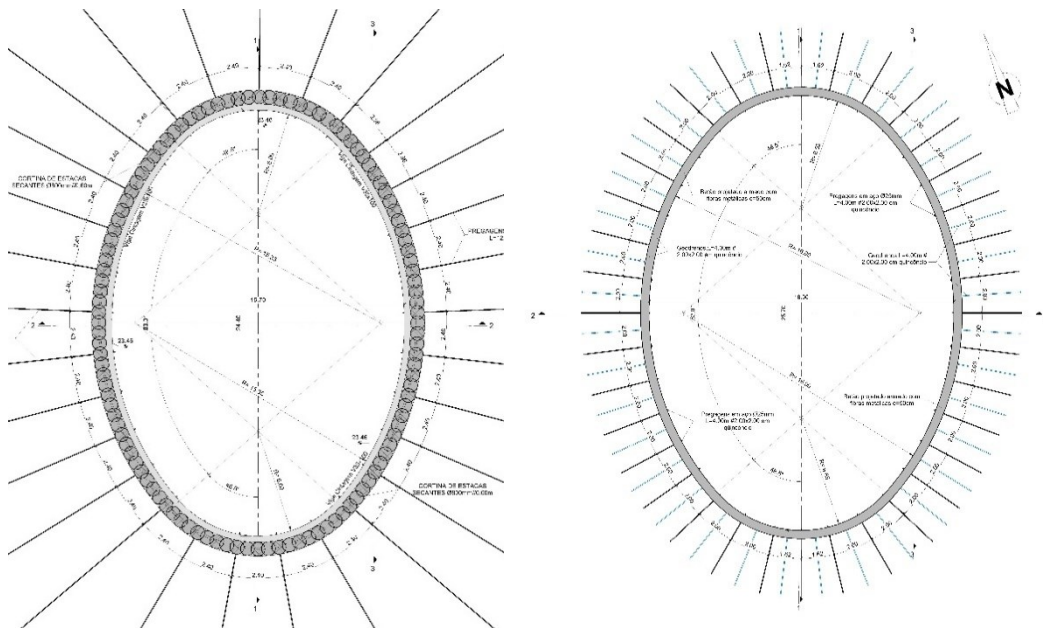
Plantas da solução de contenção provisória do poço PV217 (cortina de estacas, à esquerda; betão projetado armado com fibras metálicas, à direita)
